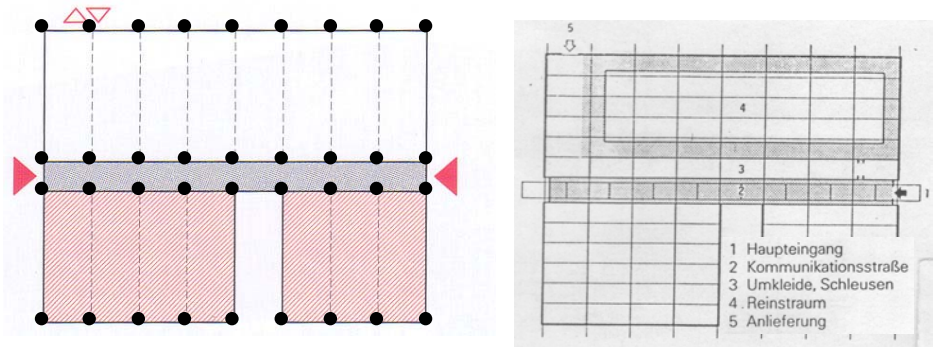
Zusammenhang von Stützpunkten und Grundrissgliederung
